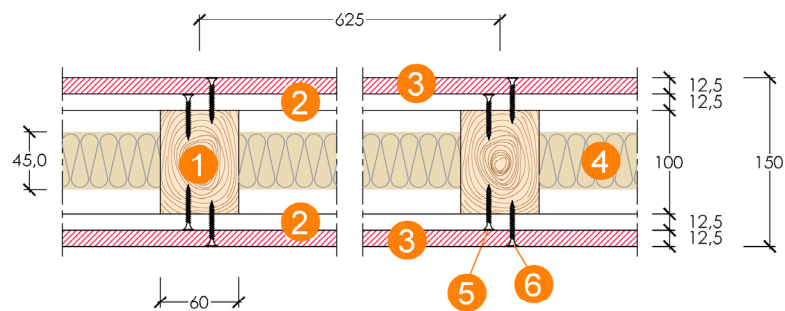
Disposizione lastre – lato non esposto / *Plasterboards layout – unexposed side
